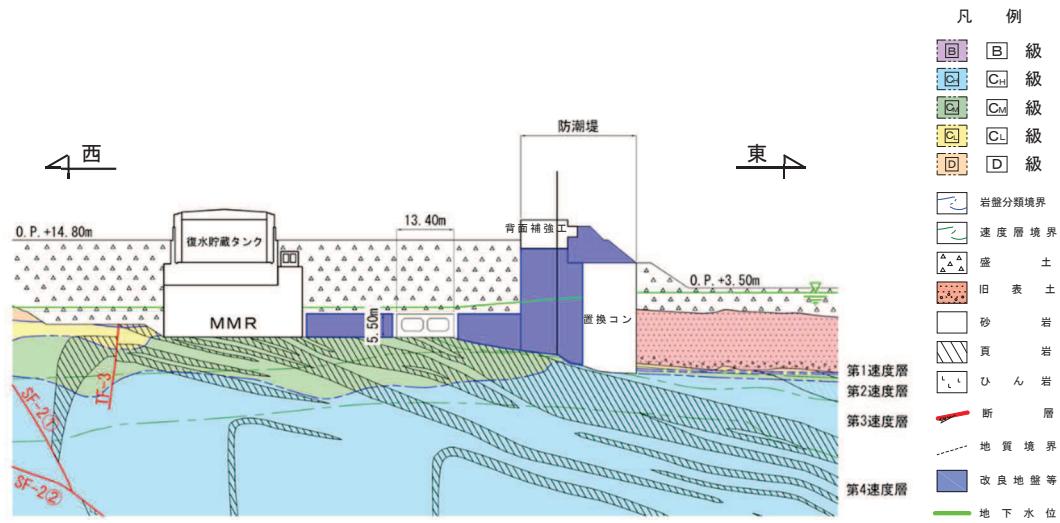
(6) 取水路（標準部） 地震時荷重算出断面図（断面⑦：曲線部）
